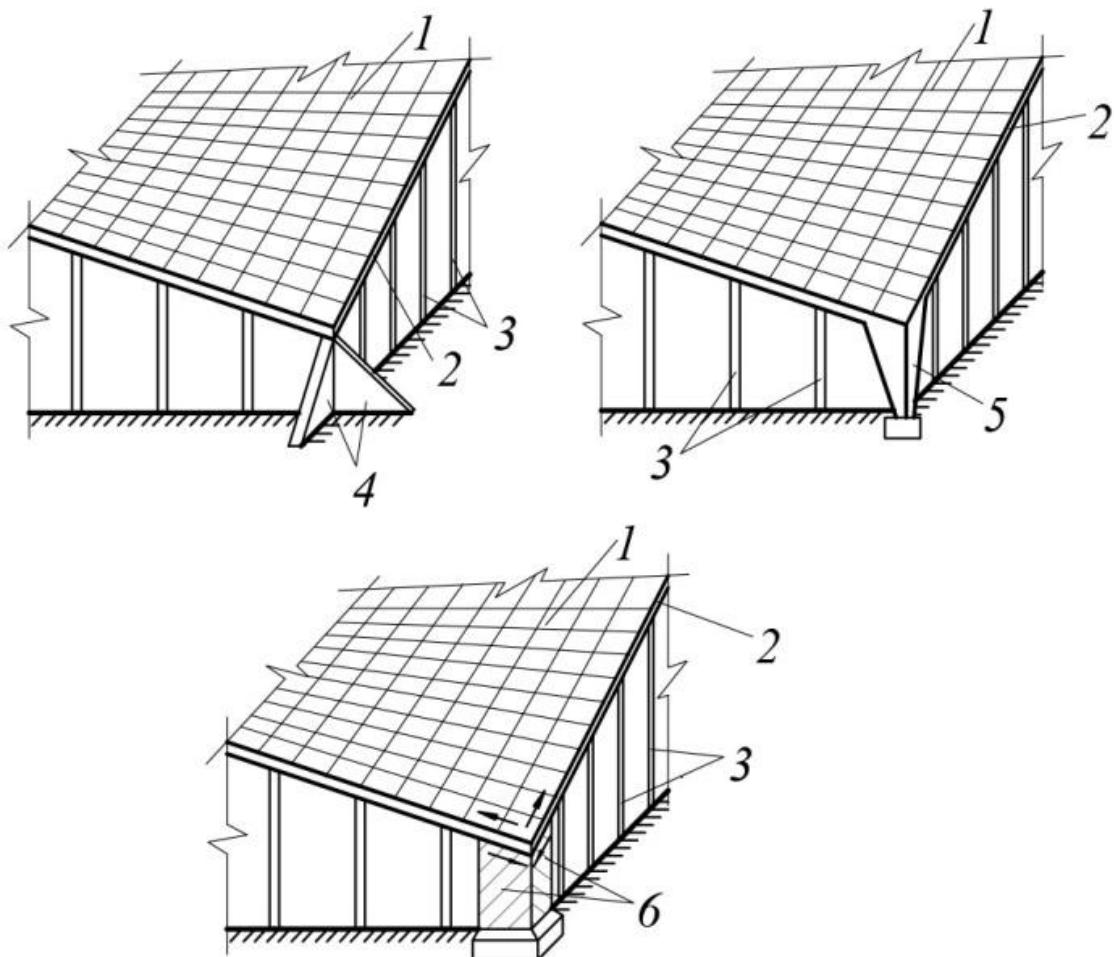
Железобетонный гипар усиленный угловыми устоями:
